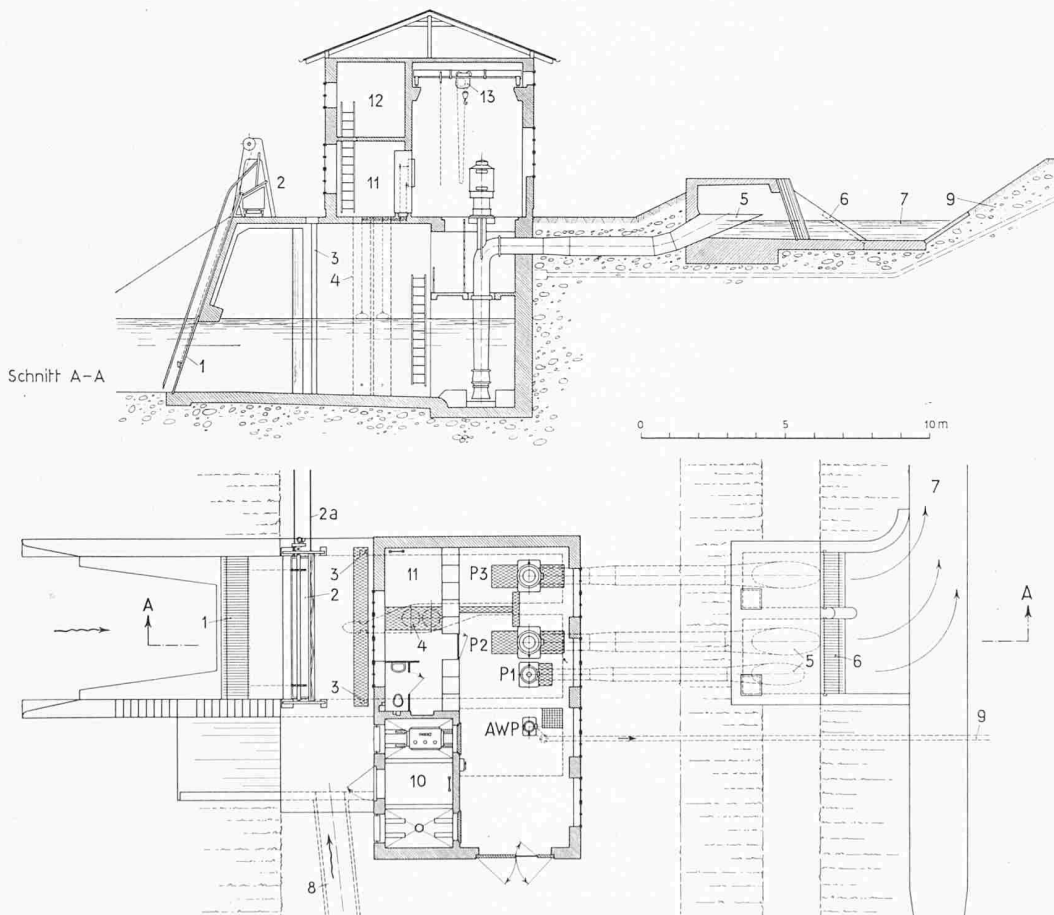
Grundriss und Querschnitt der Pumpanlage Holderbank
